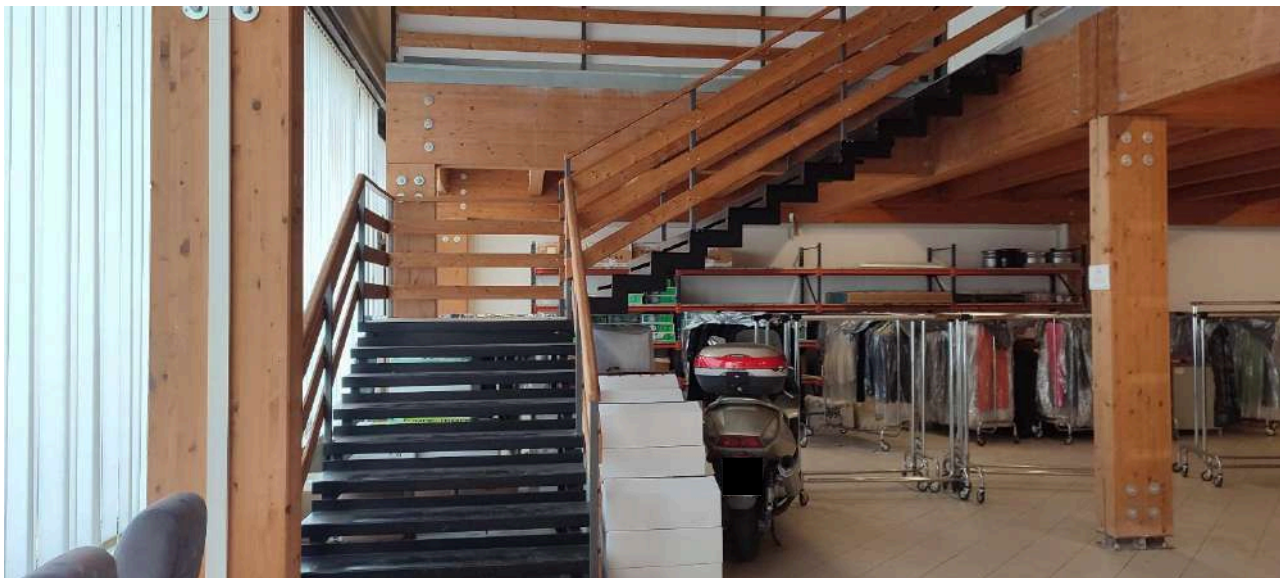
Vista interna del piano terra e dell'intradosso del soppalco
